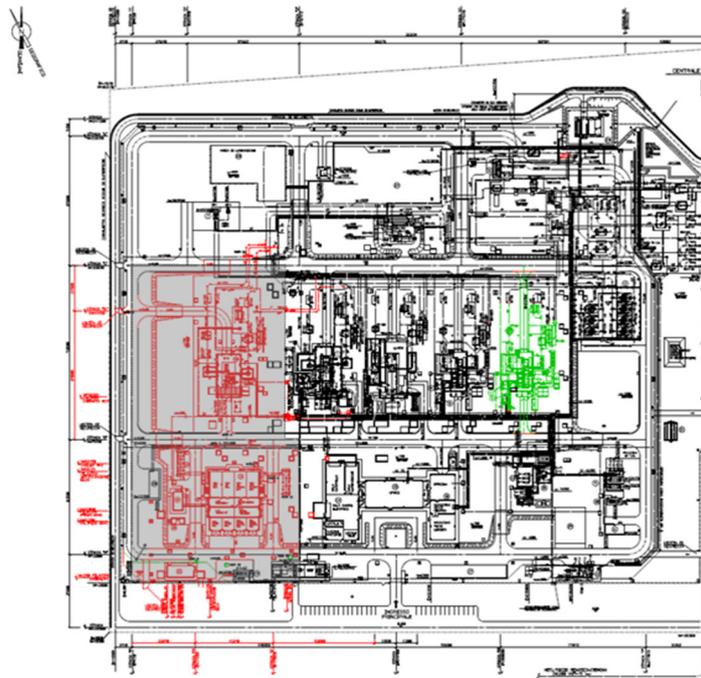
Planimetria dell'area con indicazione delle opere in progetto e ubicazione delle indagini eseguite
